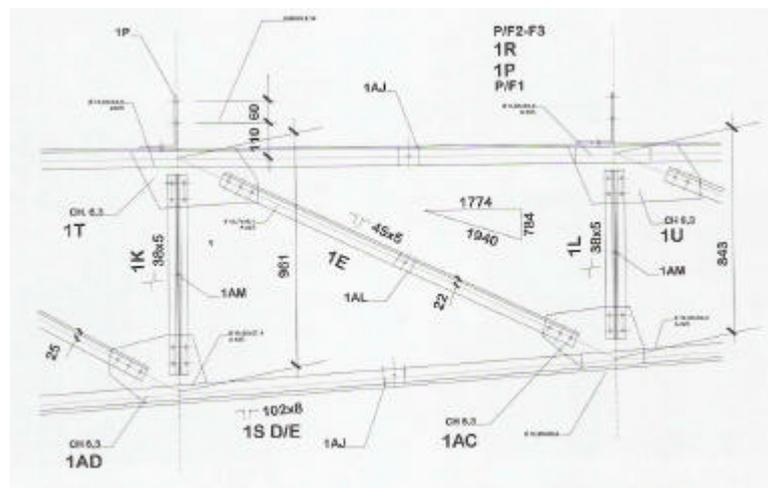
Detalhe elevação marquise metálica: projeto de fabricação.
